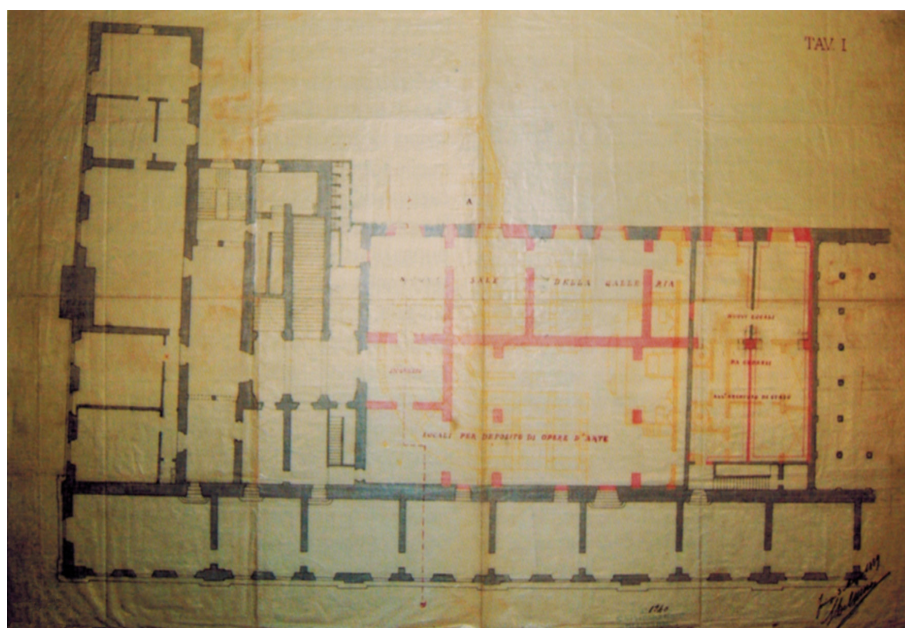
Pianta del piano primo firmata da Luigi del Moro nel 1889, con lo stato sovrapposto per la suddivisione della ex Sala del Senato, proveniente dall'Archivio Comunale di Firenze (ADS, Galleria degli Uffizi - cassetto 7).
